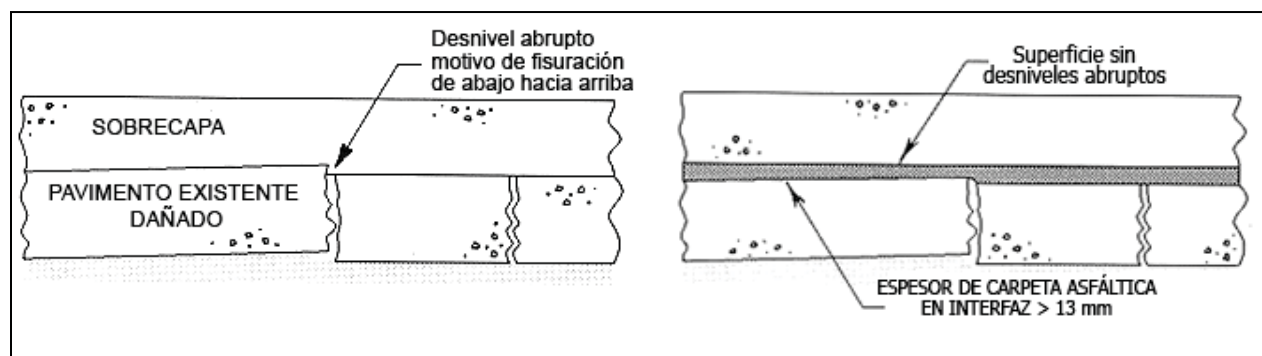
COMPARACIÓN ENTRE SOBRECAPAS DE CONCRETO LIGADA Y DESLIGADA A PAVIMENTO DE CONCRETO PRE-EXISTENTE
